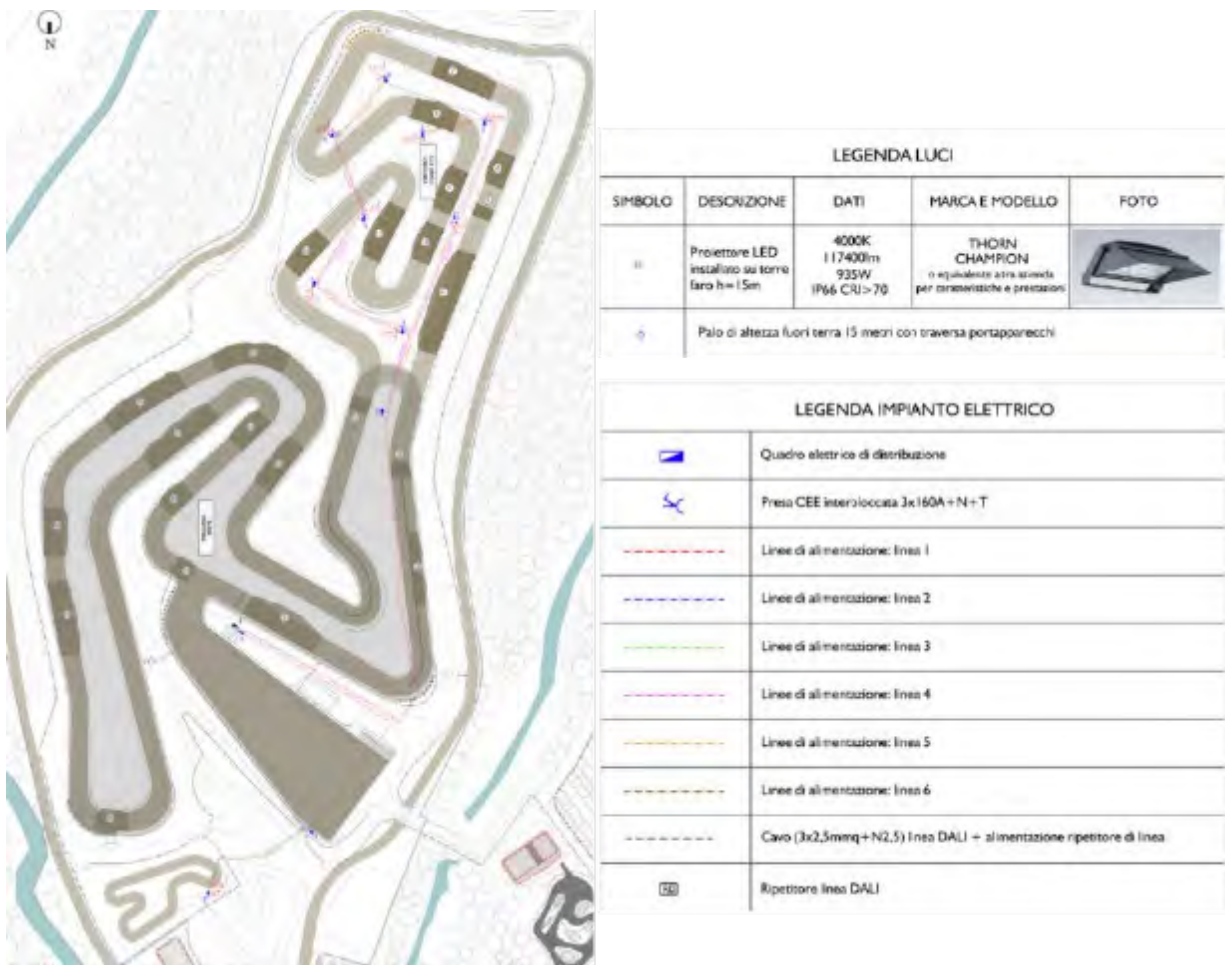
Impianto di illuminazione della pista da cross [Fonte: E2_Planimetria generale ed elaborati grafici del progetto esecutivo “Campo cross Monte Coralli opere di completamento impianto di illuminazione pista – ampliamento”]
